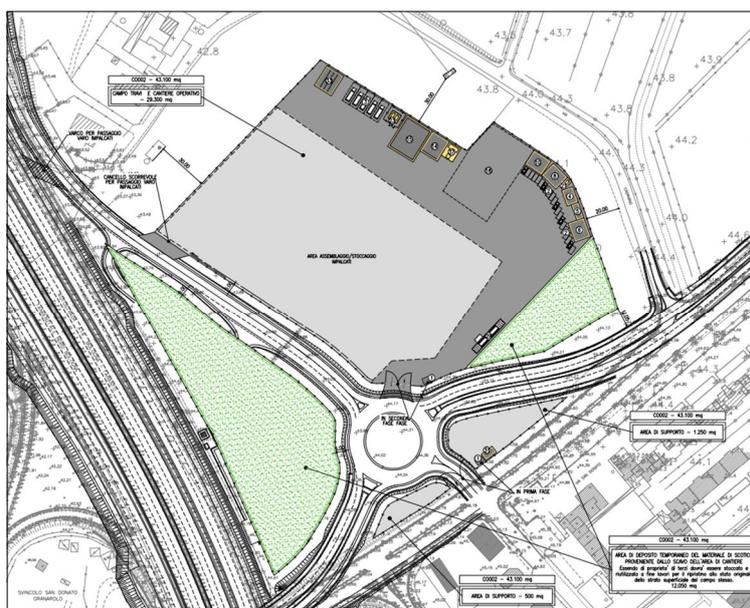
Layout dell'area di cantiere CO02 (stralcio da SIC5310)
